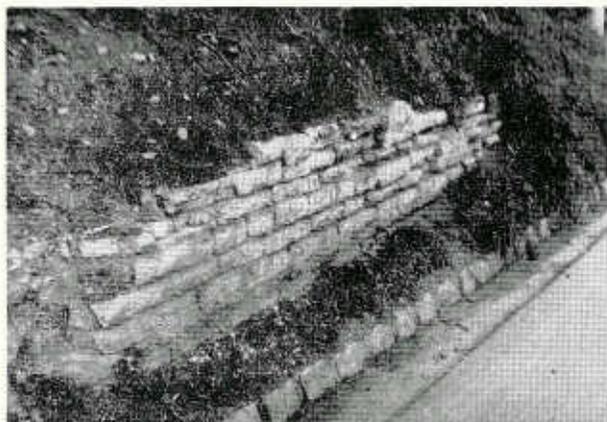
Muro antico nei pressi della tonnara di Trabia, al bivio con la strada statale 113
